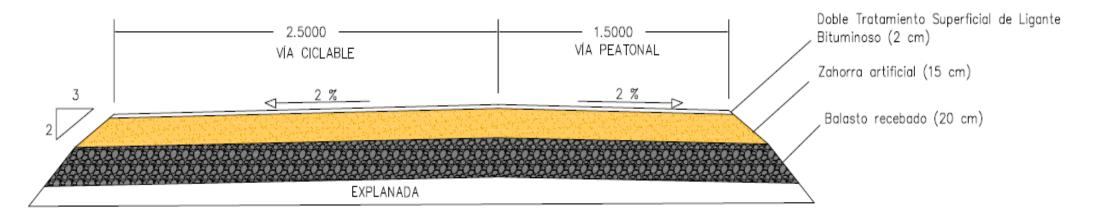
Sección Transversal Vía Verde. Fuente: elaboración propia.
